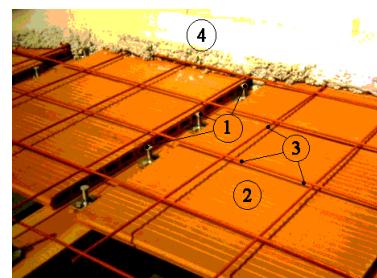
Изпълнение на подова конструкция от лепени греди, керамика и стоманобетон: 1) лепени греди от ламели; 2) монтажна арматура (поддържа арматурната мрежа на "работно" ниво във височина); 3) плоски тухли; 4) арматурна мрежа от J 6 [mm]; 5) тънка бетонна плоча;
